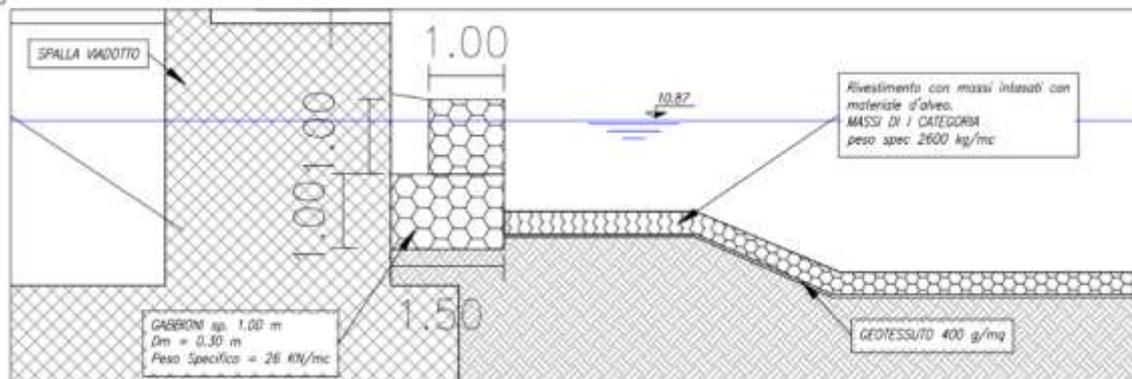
Dettaglio della sistemazione canale sulla spalla del viadotto VI07 (da PD).
